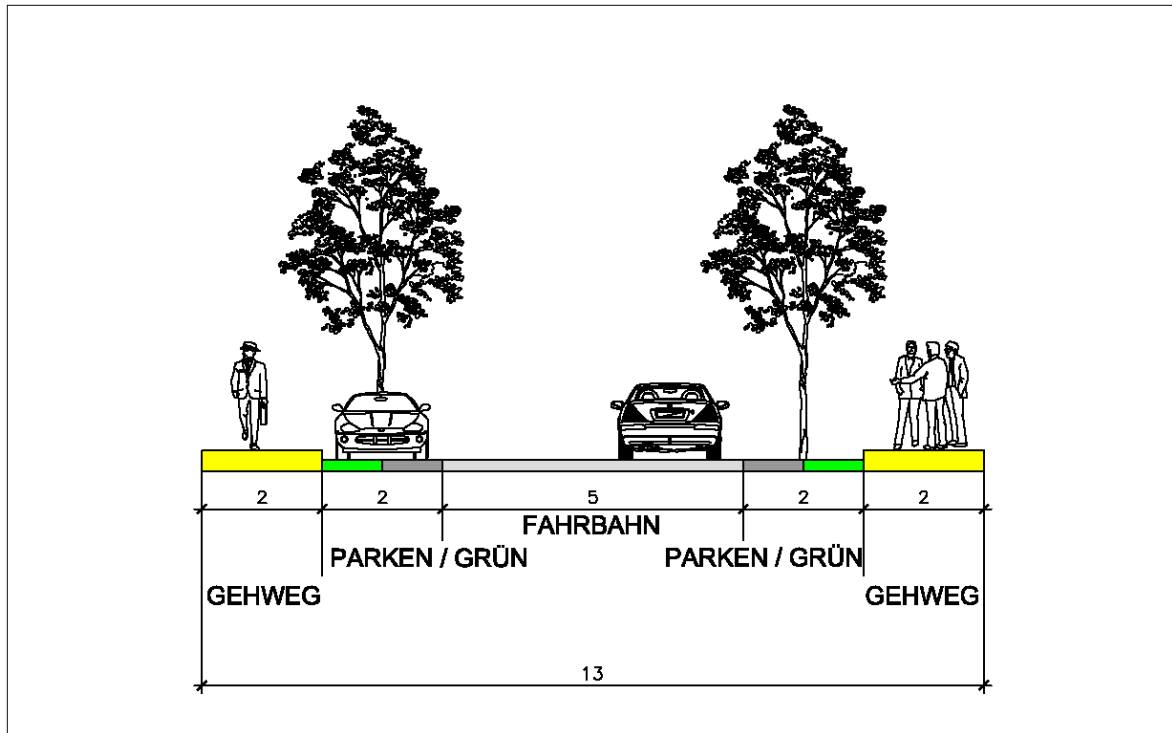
Querschnitt Haupterschließung Baufeld 2 + 3
